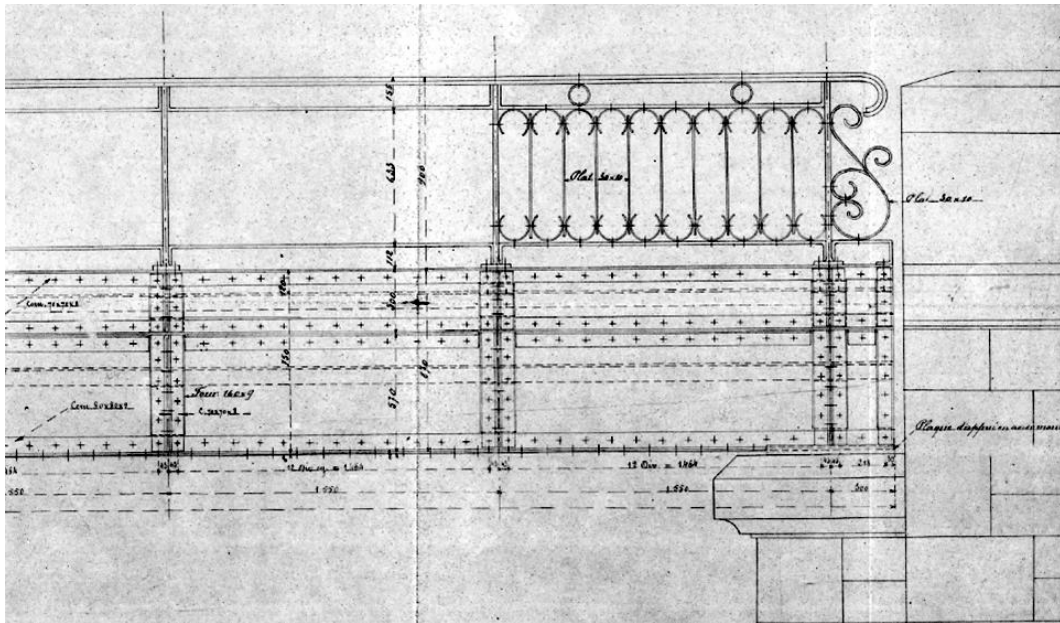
Extrait du plan n°10 : Élévation longitudinale de la travée 0 – zoom sur la ligne d'appui Culée C0 côté Tasdon.
